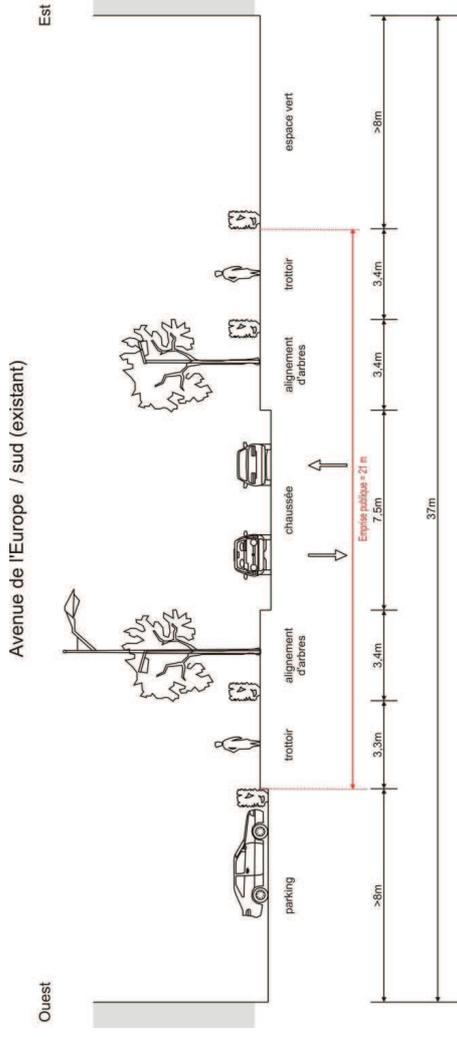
Situation existante (coupe 28) avenue de l'Europe / section "Sud"
